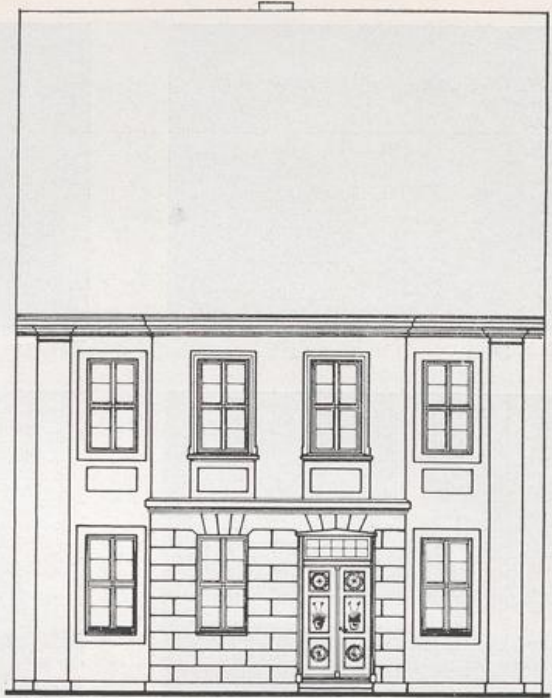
Haus Friedrichstraße 14 nach Brasch's Entwurf
